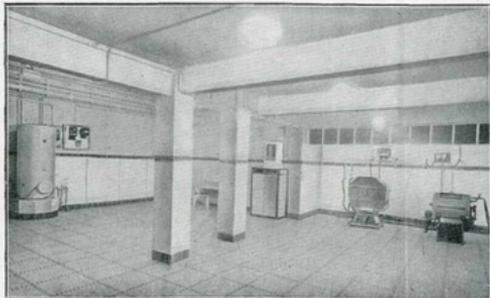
VUE D'ENSEMBLE DE LA BUANDERIE
